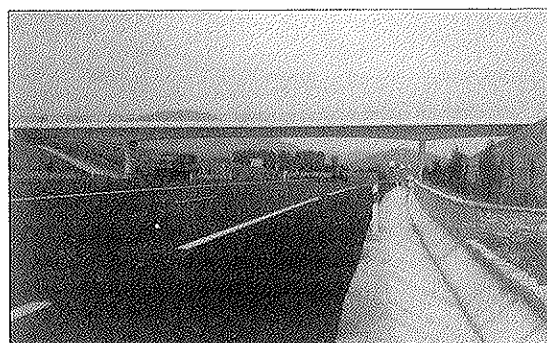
Vista general del puente, totalmente construido con la autovía en servicio. Se aprecia la esbeltez propia de la viga continua de canto variable. Una vez concluida la obra, no se distinguen las juntas de construcción entre los tres tramos de la viga principal.
